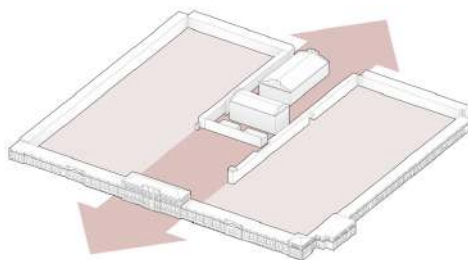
Rzut dachu fabryki Scheiblera z 2024 roku [opracowanie własne]
